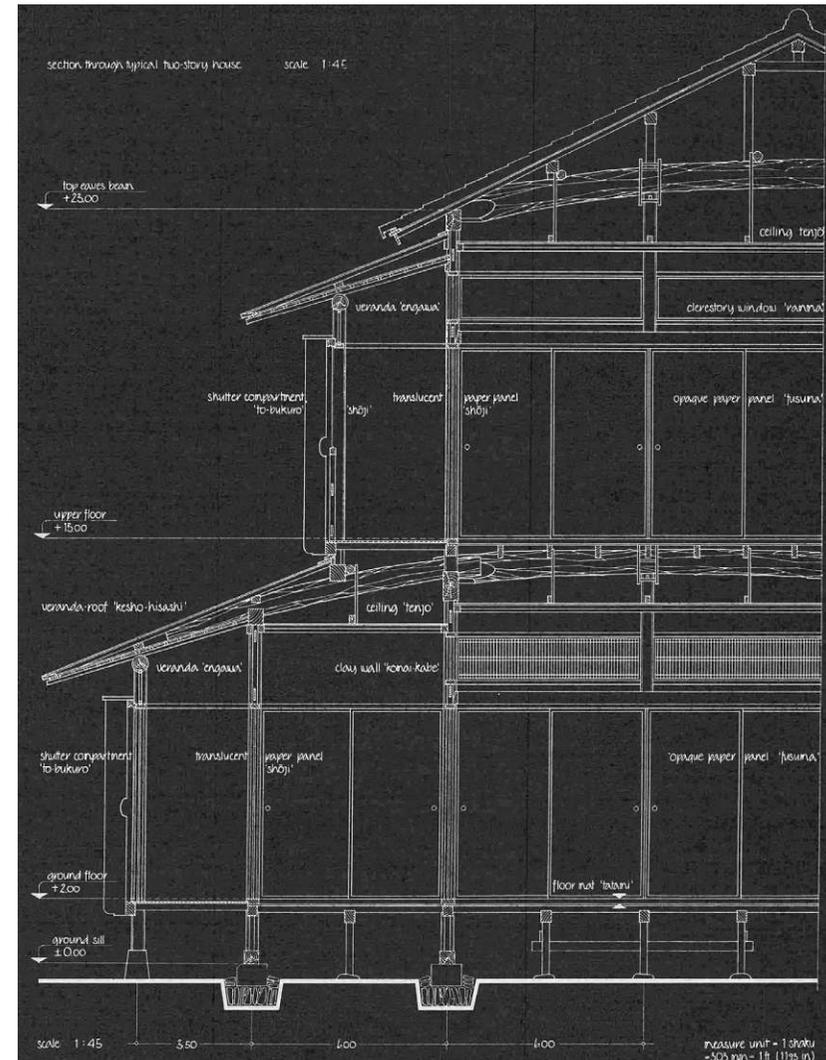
Schnitt durch ein zweigeschossiges traditionelles Haus
